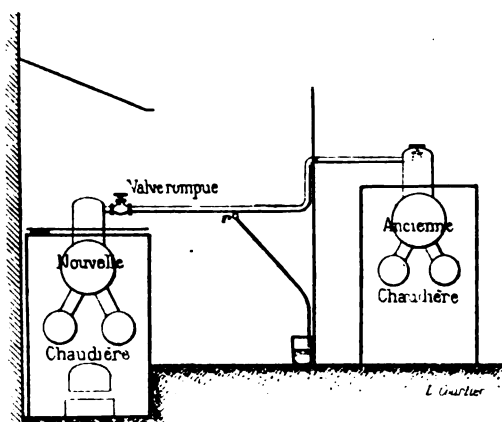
et 16. — Coupe et plan de l'installation, dans une brasserie, à Paris.
